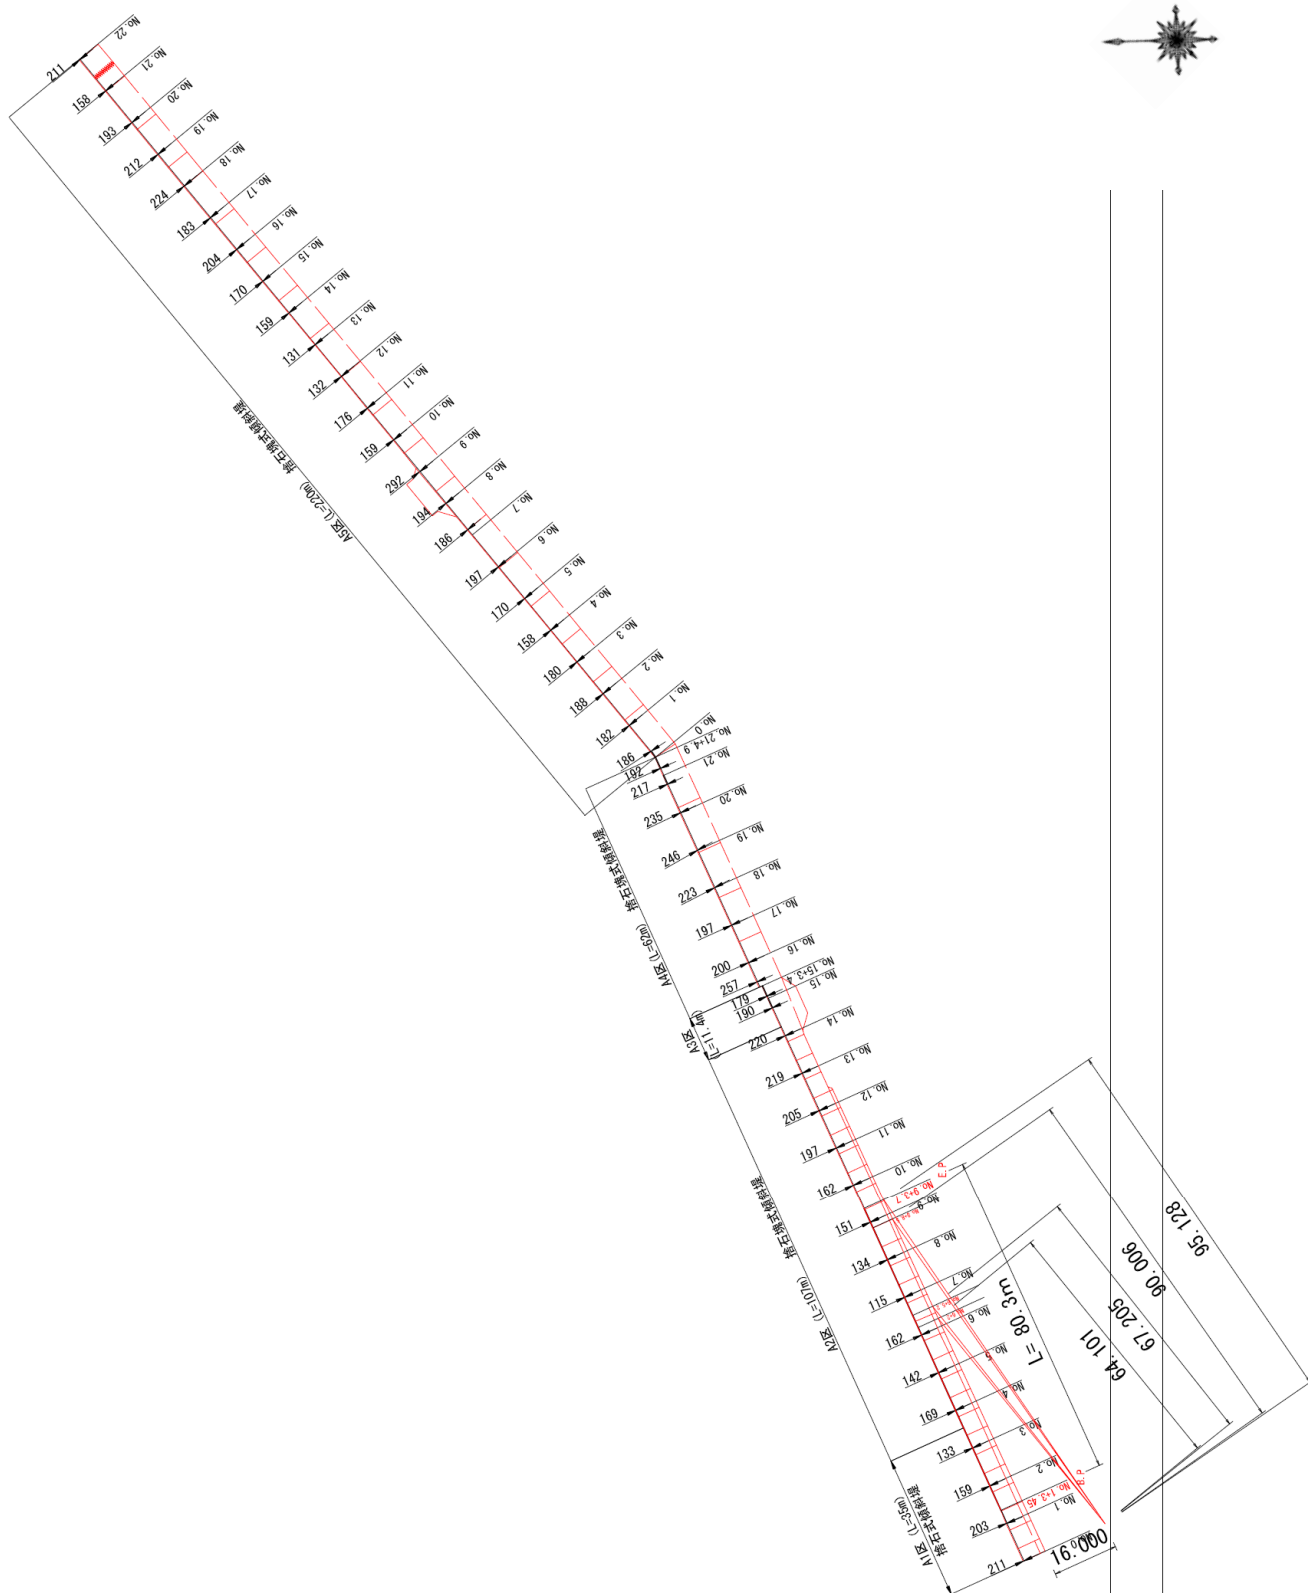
No. 6 船溜南防波堤の平面図（被災後）
